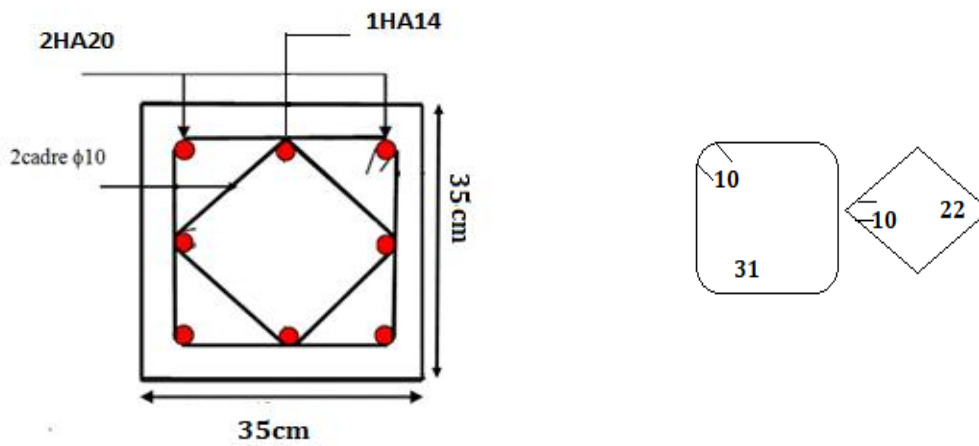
Schéma de ferrailage de poteau 5<sup>eme</sup> et 6<sup>eme</sup> étages.
